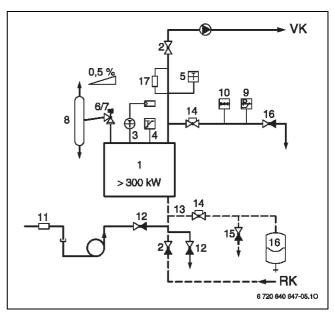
Sicherheitstechnische Ausrüstung nach DIN EN 12828 für Heizkessel >300 kW, STB < 110 °C
